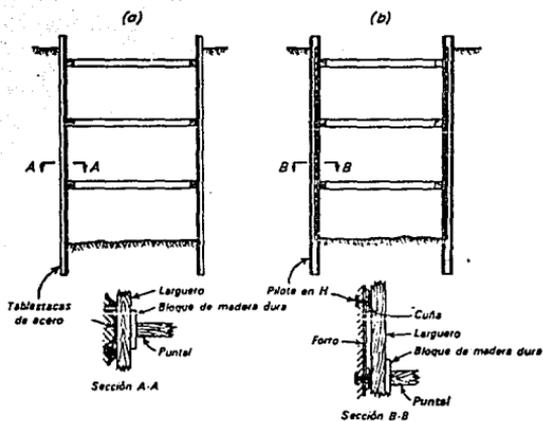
SECCIONES TRANSVERSALES EN APUNTALAMIENTOS TÍPICOS DE EXCAVACIONES PROFUNDAS a) TABLESTACAS DE ACERO b) PILOTES H Y FORRO.
